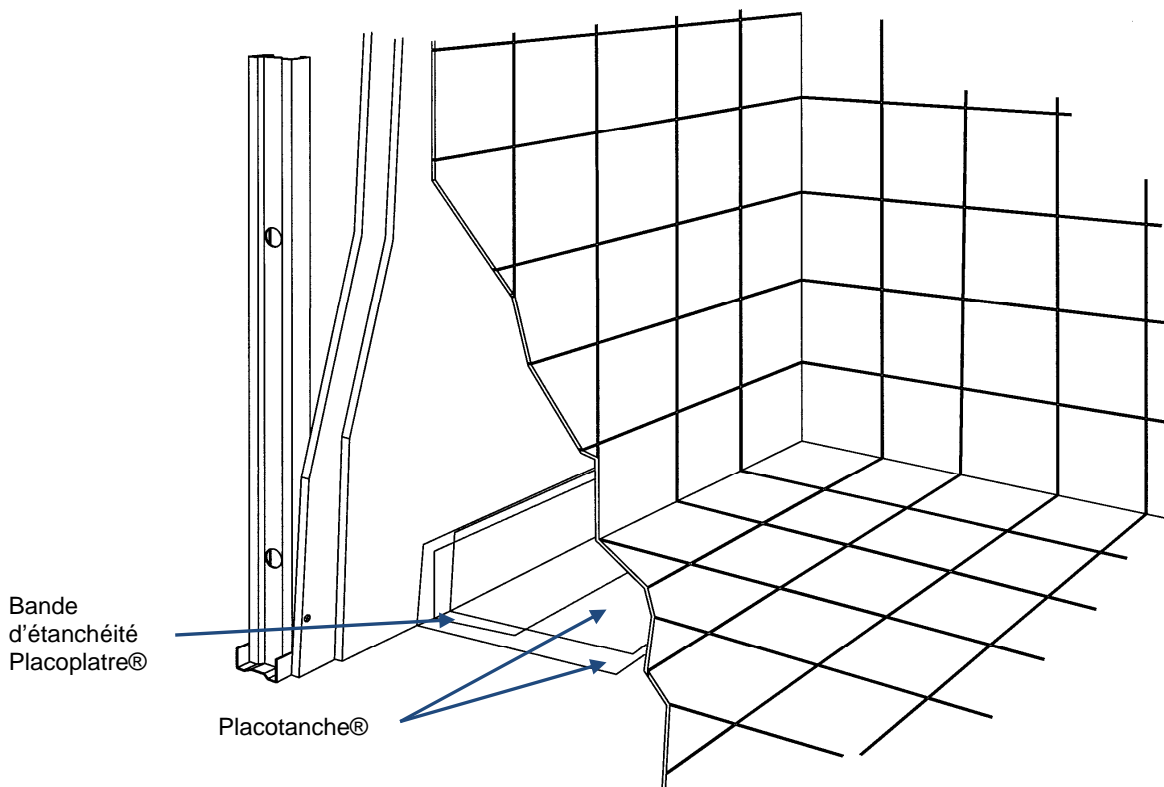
Local EB+ collectif ou EC – Protection en pied de cloison – Cas de finition par carrelage.
